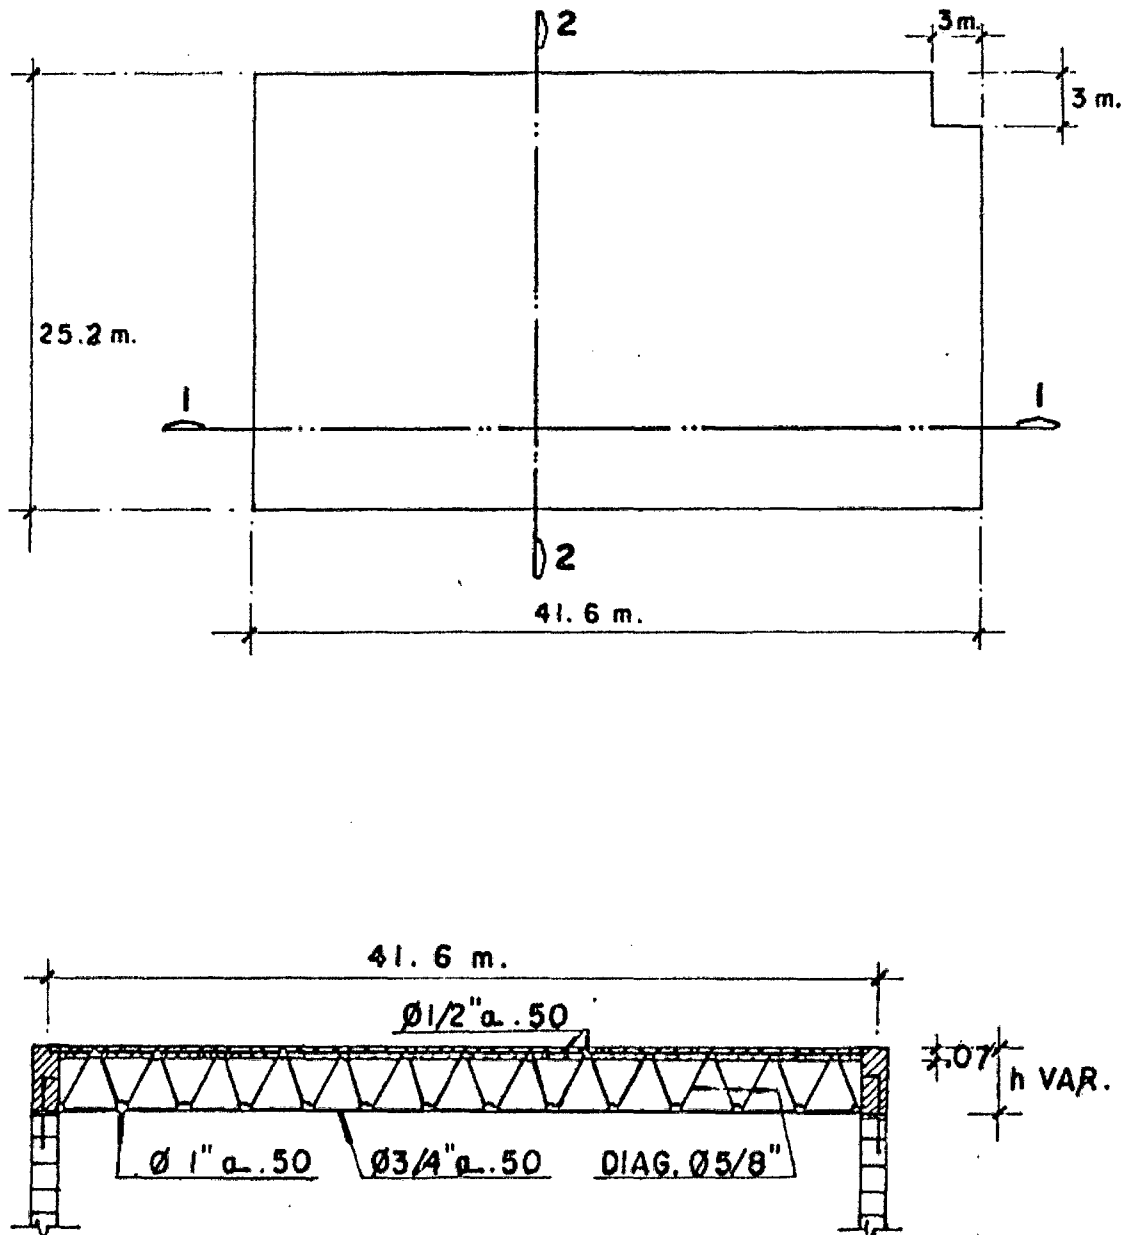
Plano en planta y la sección 1-1 cobertura peralte variable EEC.
